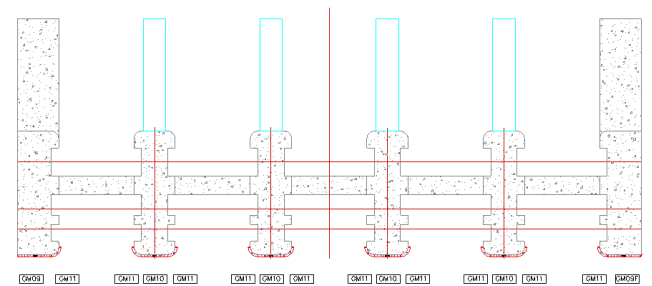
1#、3#、5#、7# 拦污栅 3-39 层模板平面布置图
